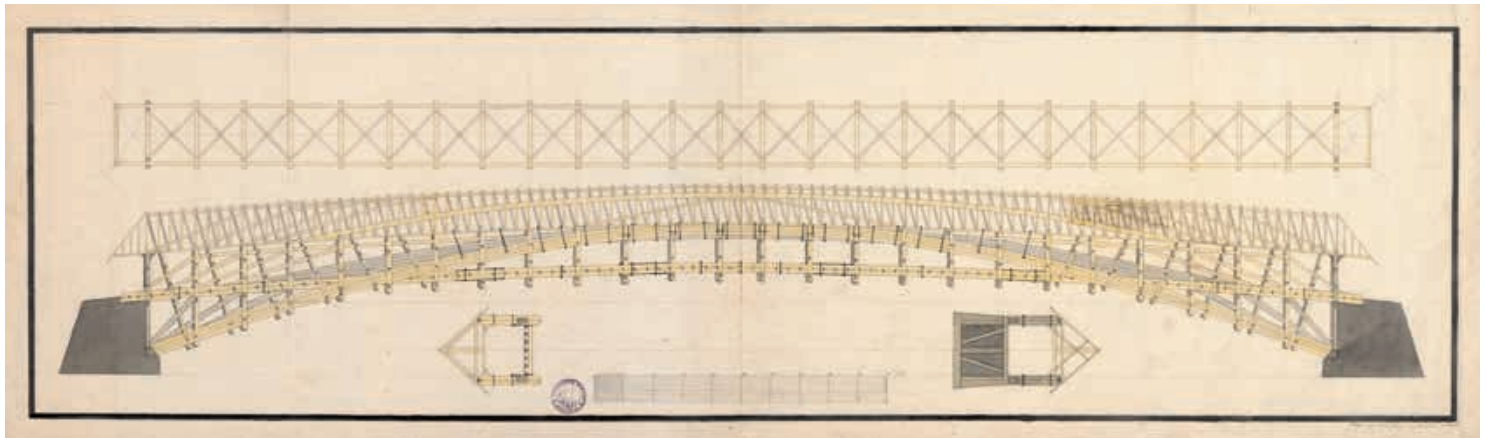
Entwurfsplan einer Brücke über die Thur: «Plan d'un Pont de bois d'une seule Arcade & Couvert. Design par Jacob Fuss le 26 juin à Genève». 102,7 × 31,2 cm. © AEG Travaux B 4/26, Archives d'Etat de Genève
